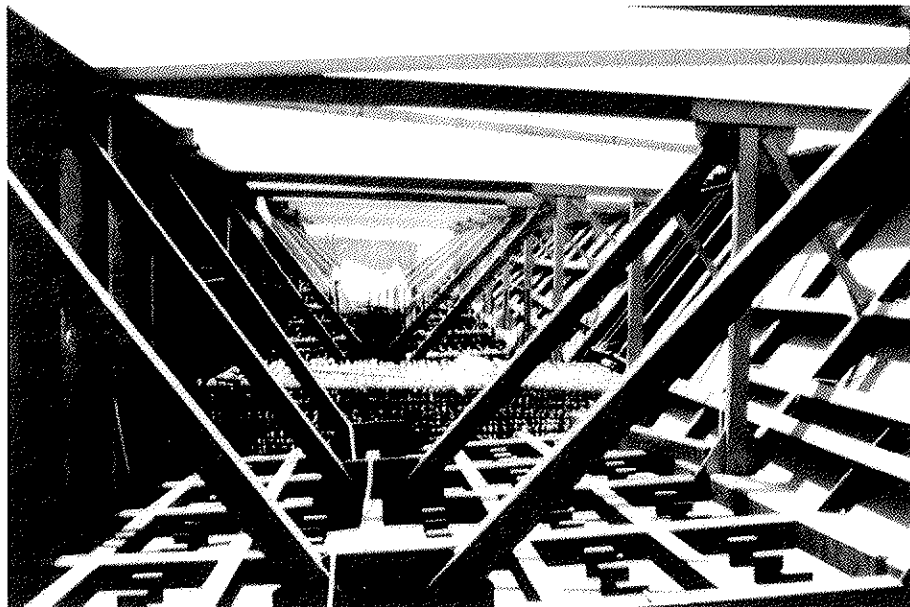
Interior de la viga cajón antes de hormigonar el fondo.
